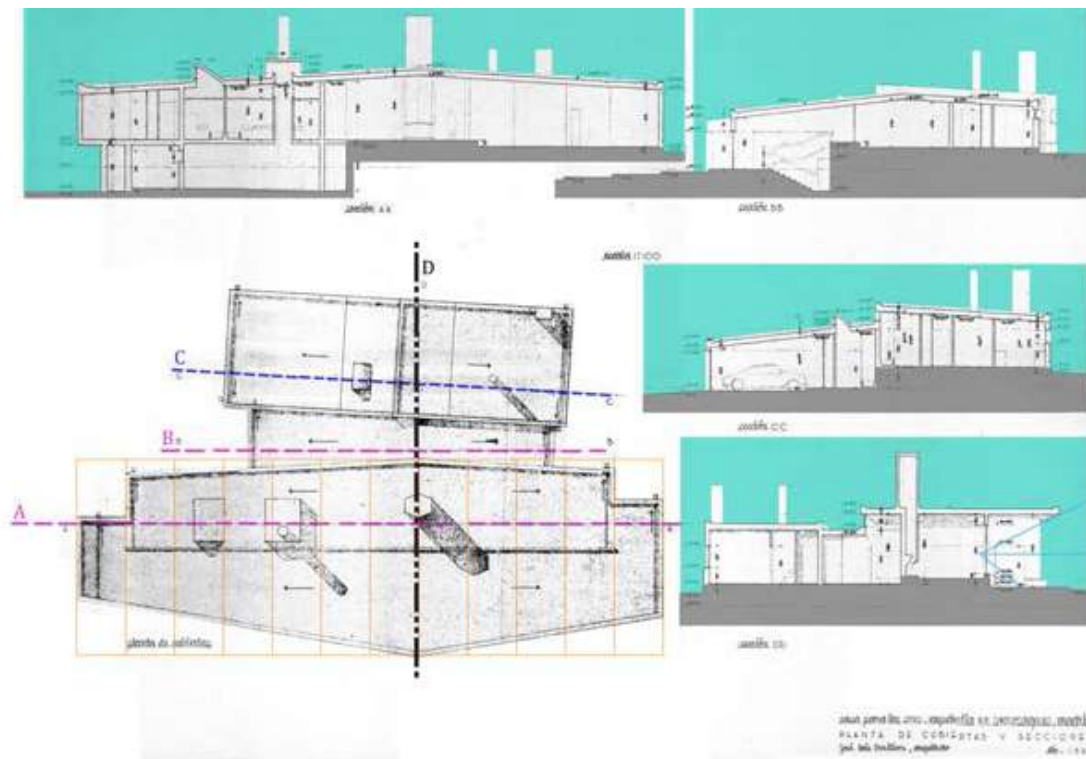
Planta de cubiertas y secciones de la casa Capdevila. Diciembre de 1963. Archivo de Arquitectos Mexicanos
